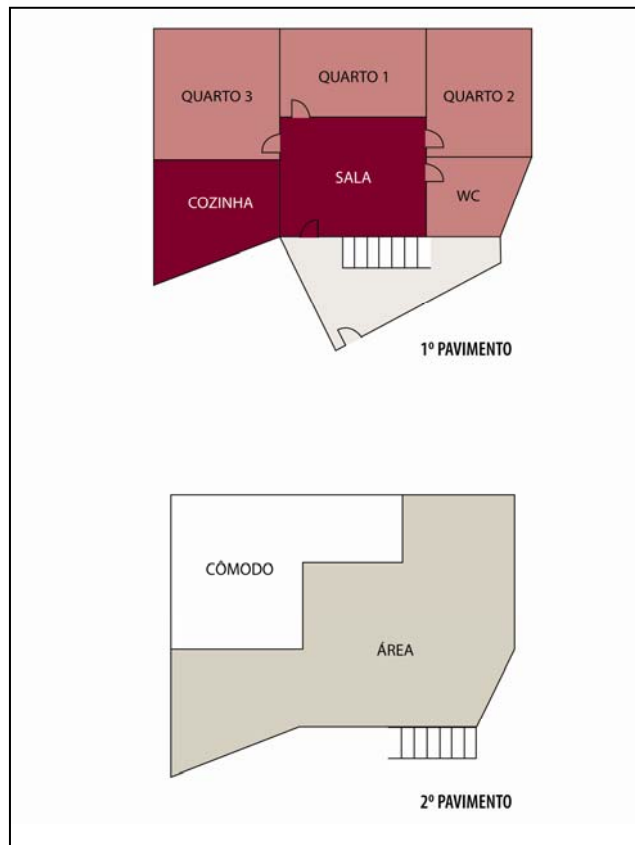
Planta de casa na Vila N. Sra. Aparecida (Rua Falcão).
